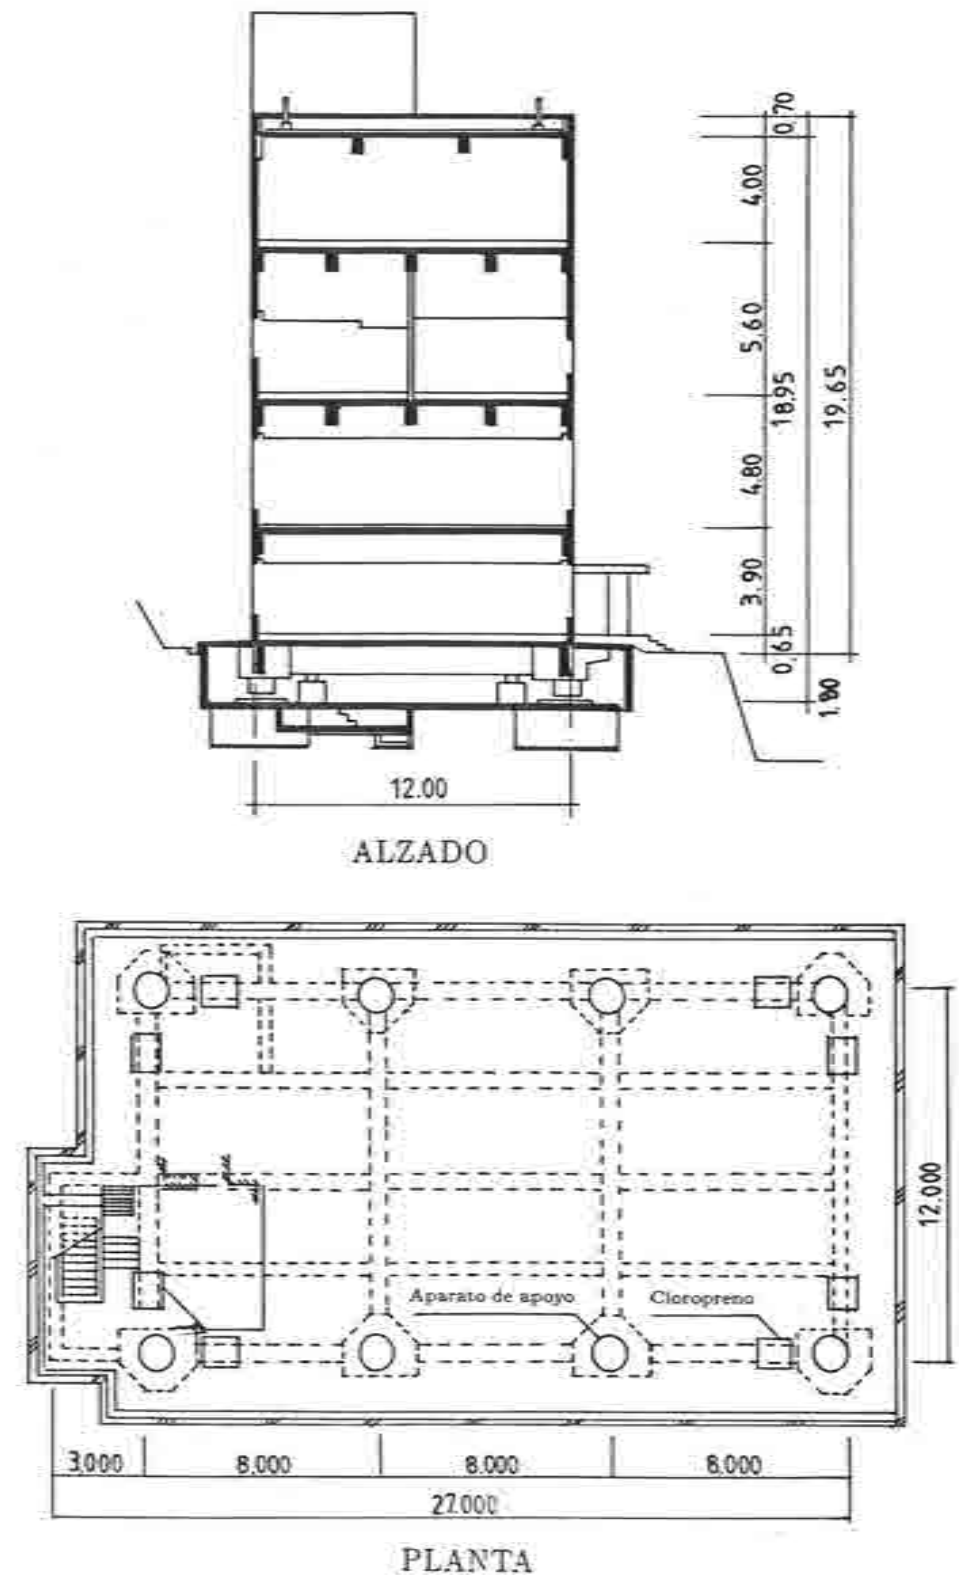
Planta y alzado del Centro de Investigación Tecnológica de Taisei Corporation.
